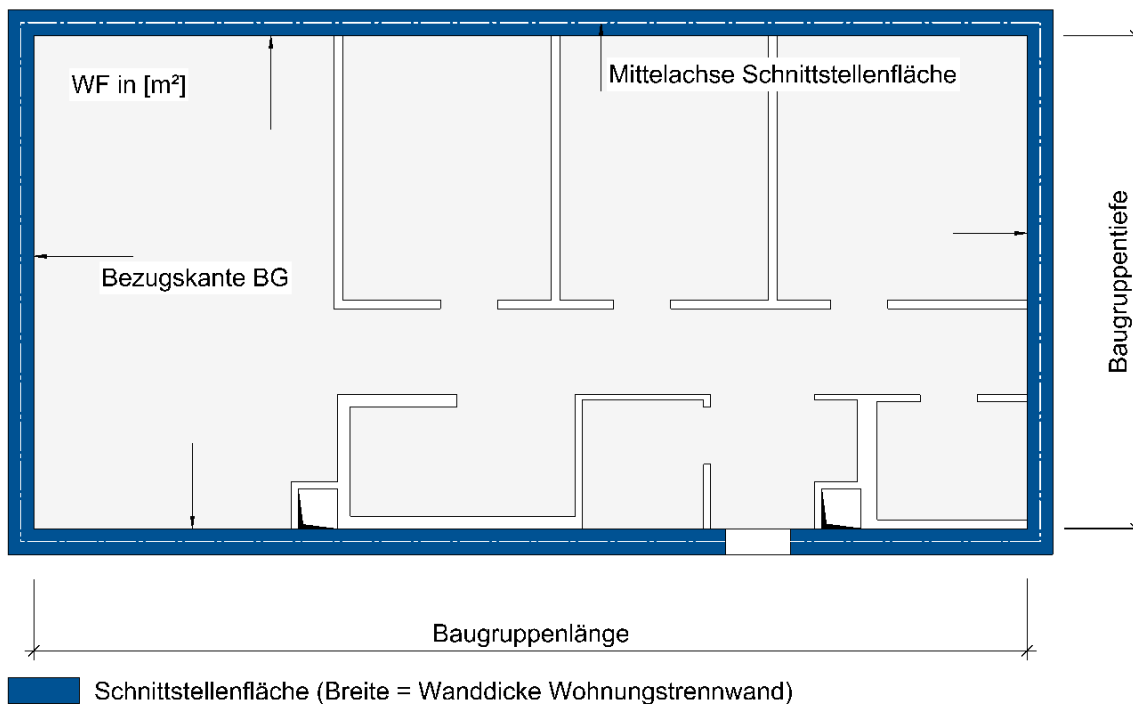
Geschossgrundriss einer Baugruppe mit der Außenwanddicke gleich der Wohnungstrennwand
